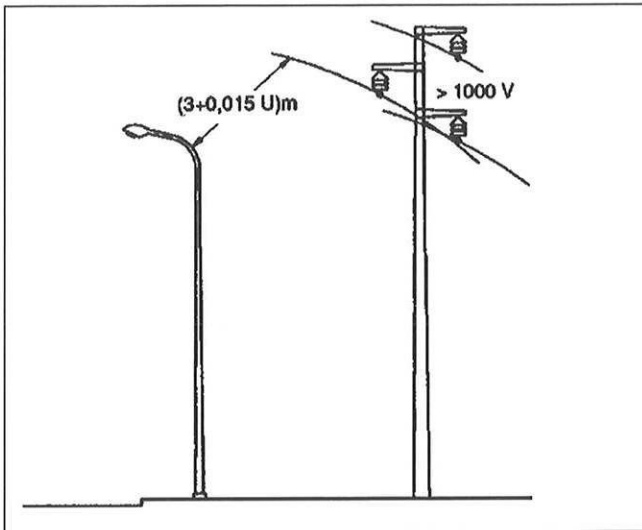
Distanza di rispetto tra apparecchi illuminanti e linee aeree nude a tensione superiore a 100V.
